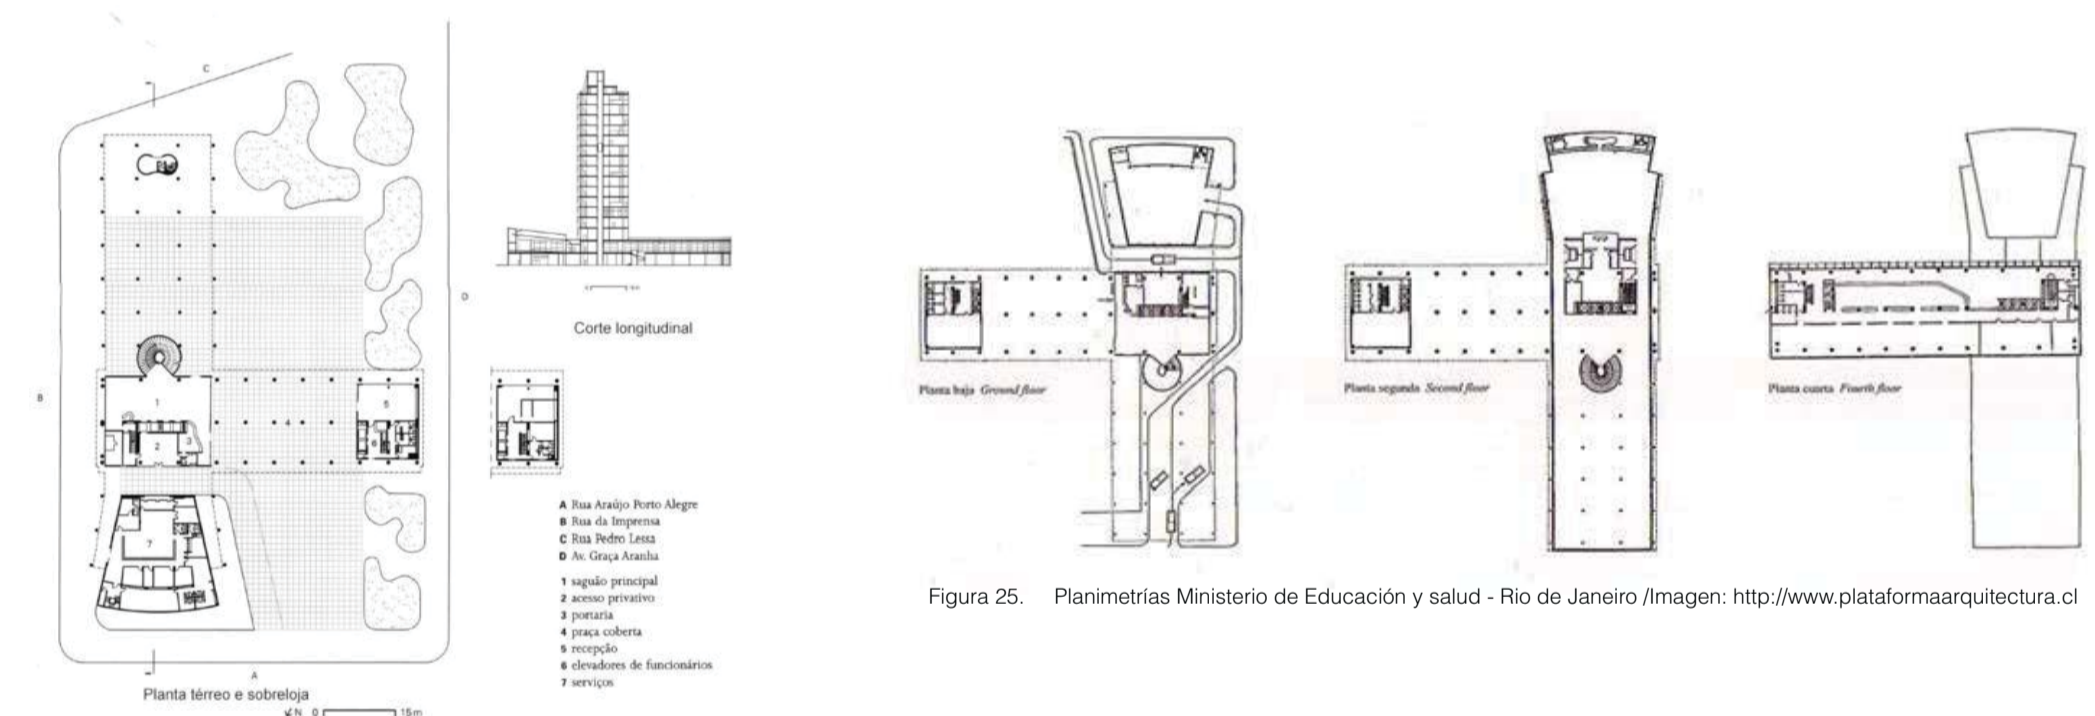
Planimetrías Ministerio de Educación y salud - Rio de Janeiro /Imagen: <http://www.plataformaarquitectura.cl>
